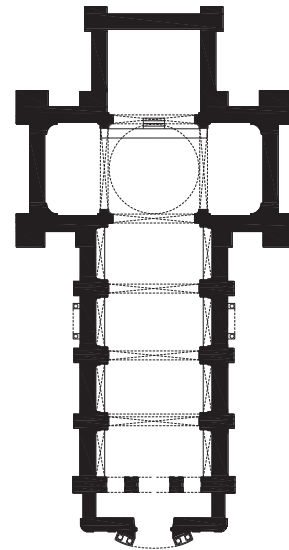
PLANTA ARQUITECTÓNICA.
